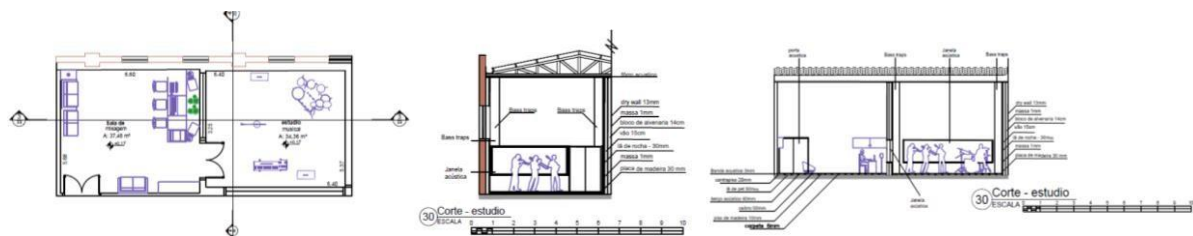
Planta e corte detalhado da sala do estúdio musical
